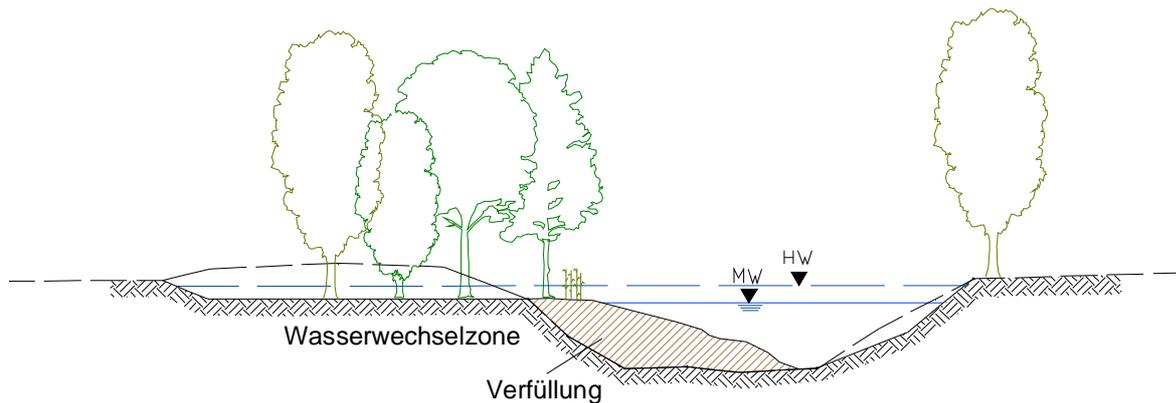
Prinzipskizze einer einseitigen Wechselwasserzone, Querschnitt
